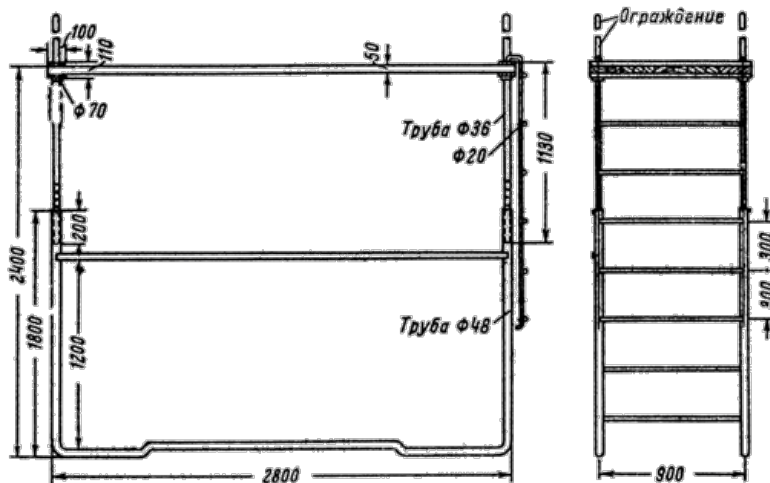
Инвентарный трубчатый столик для монтажа опалубки
